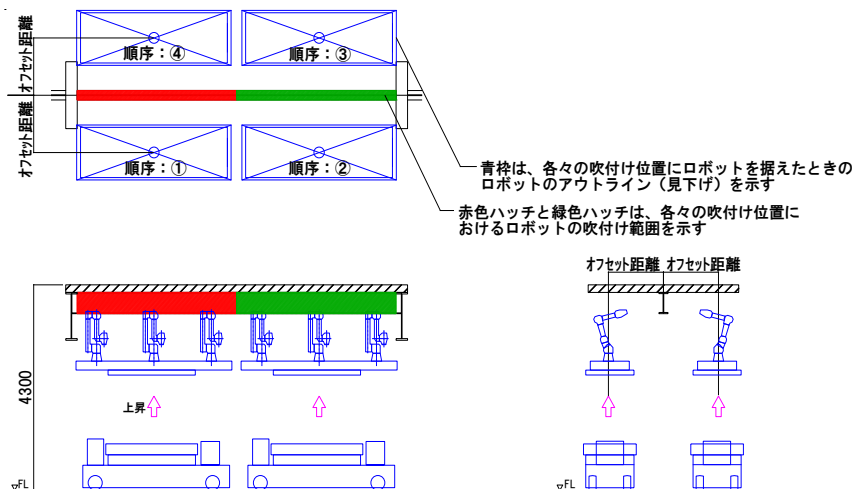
吹付け施工時のロボットの配置 (小梁の場合)
